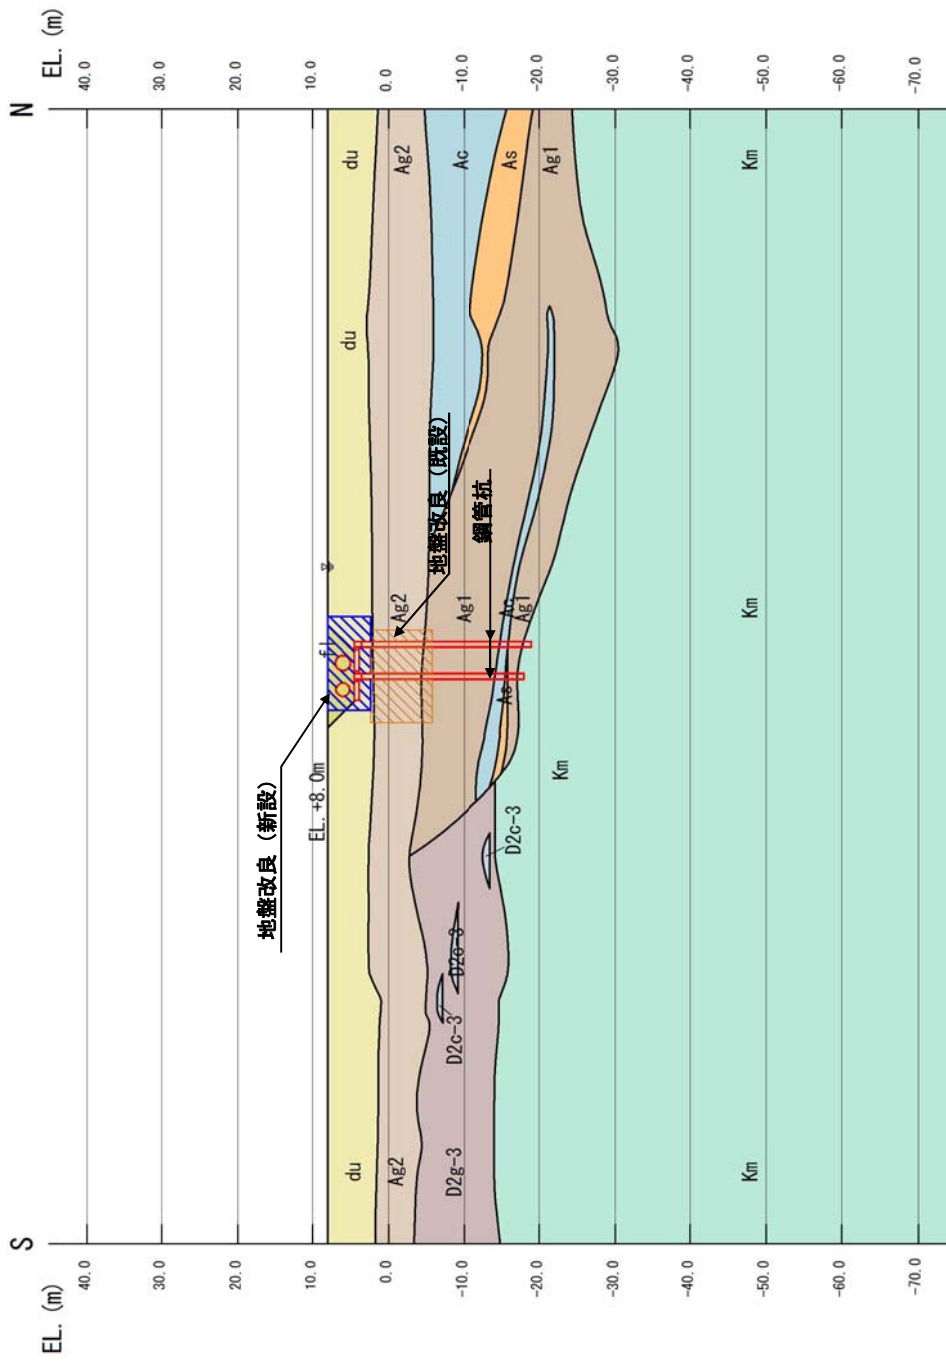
(3) 屋外二重管基礎の評価対象断面図 (C-C 断面・杭基礎部)
